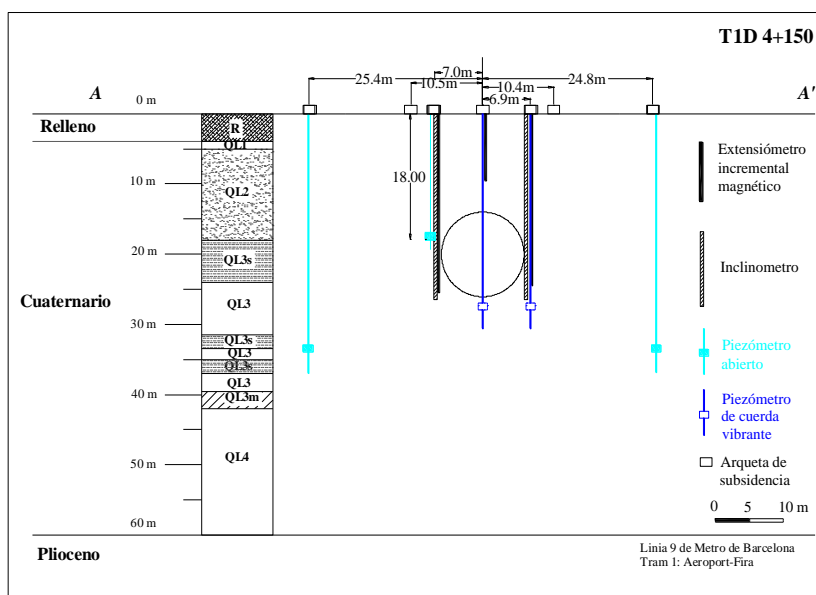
14. Perfil de la instrumentación instalada en la sección de control TID PK 4+150
